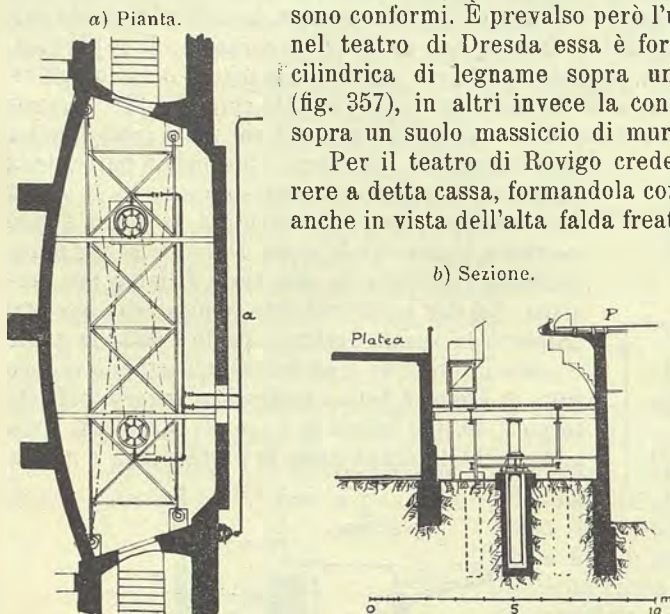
a, b. — Disposizione dell'orchestra a piano mobile nel teatro Reale di Wiesbaden.
